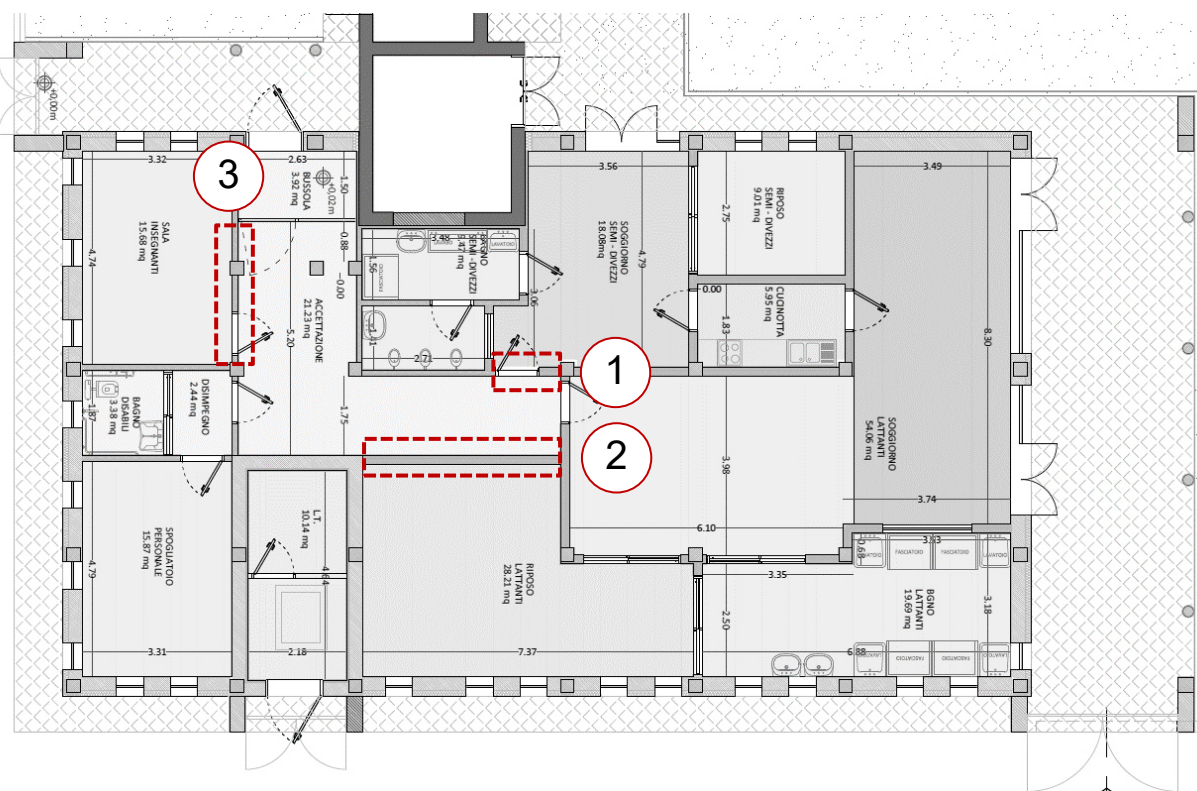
Planimetria di progetto del piano terra con indicazione delle pareti verificate rispetto l'isolamento con gli ambienti comuni
